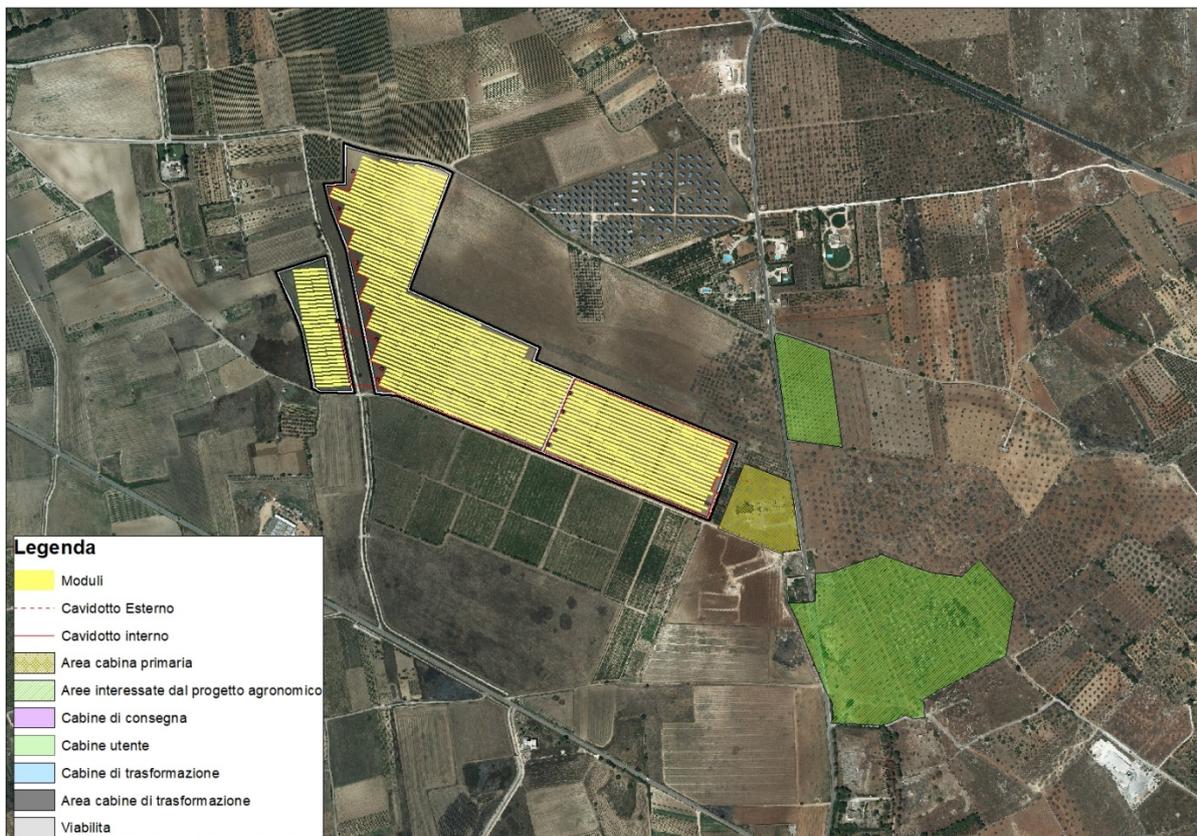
DETTAGLIO LAYOUT PROPOSTA PROGETTUALE
